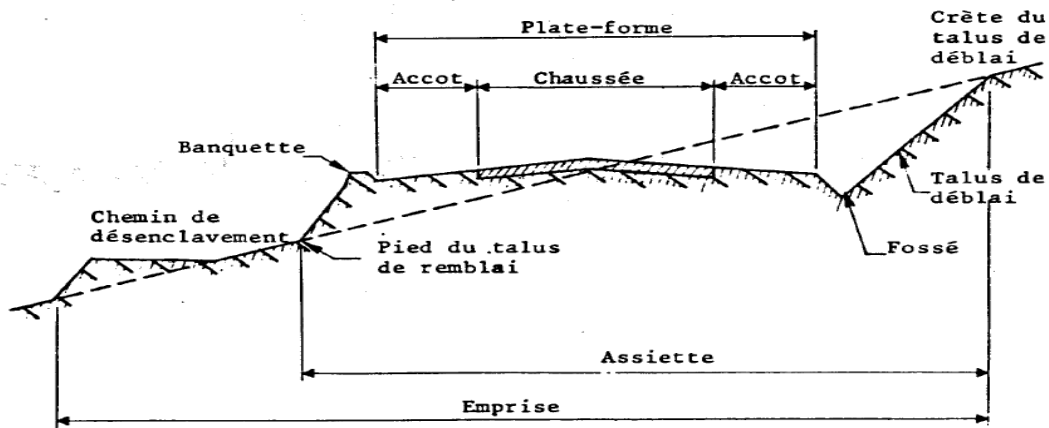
Profil en travers type : chaussée bidirectionnelle
